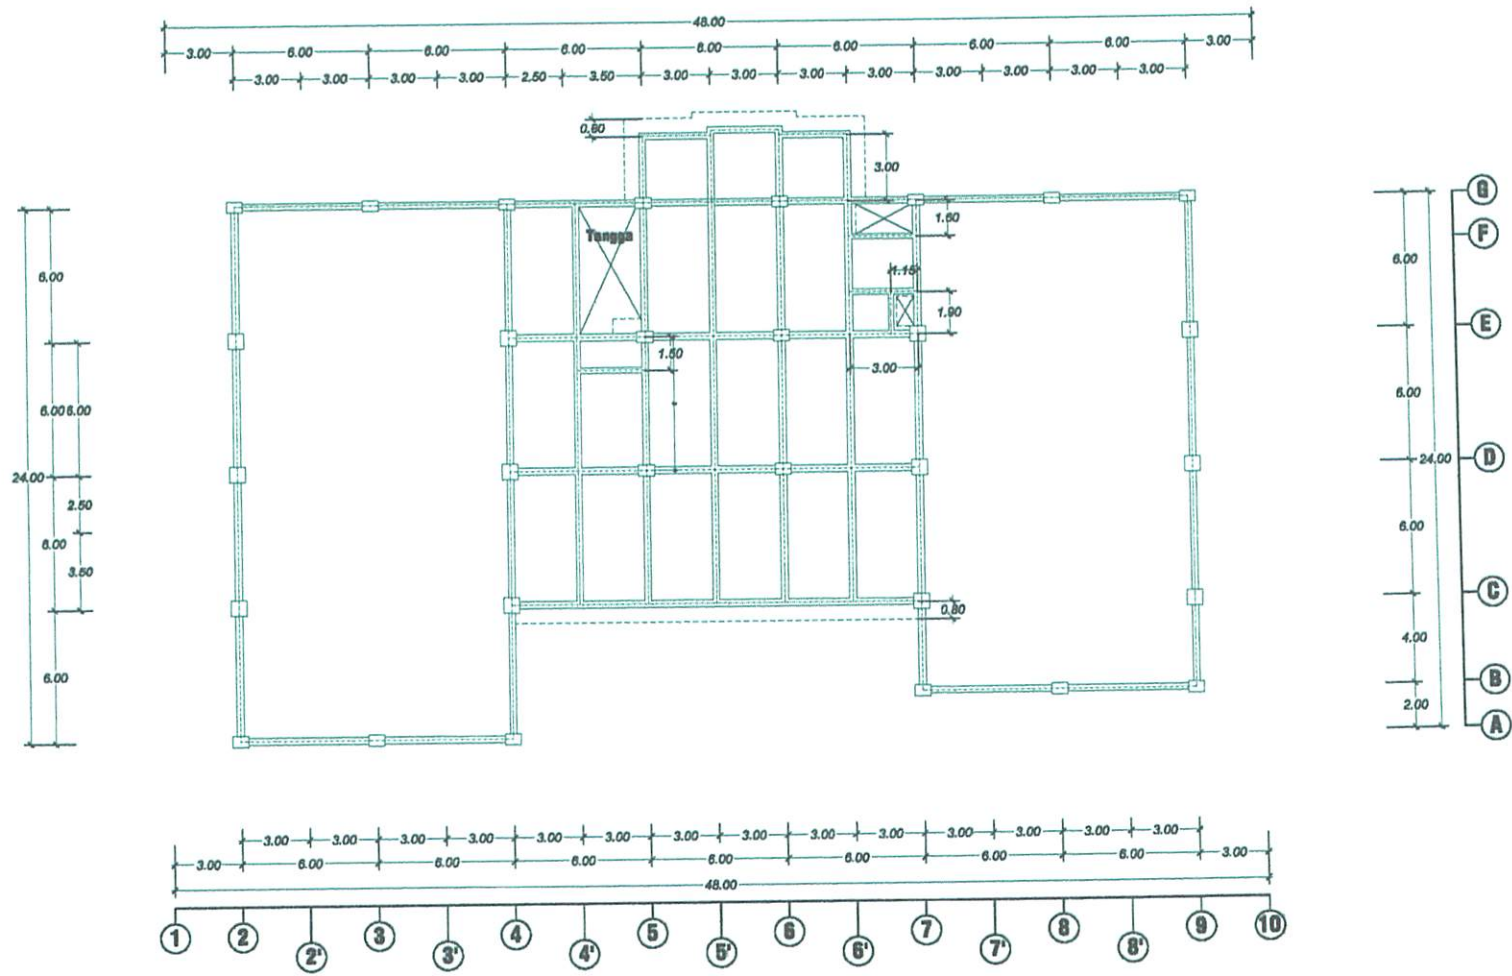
Denah Balok Dan Kolom Lt 8
